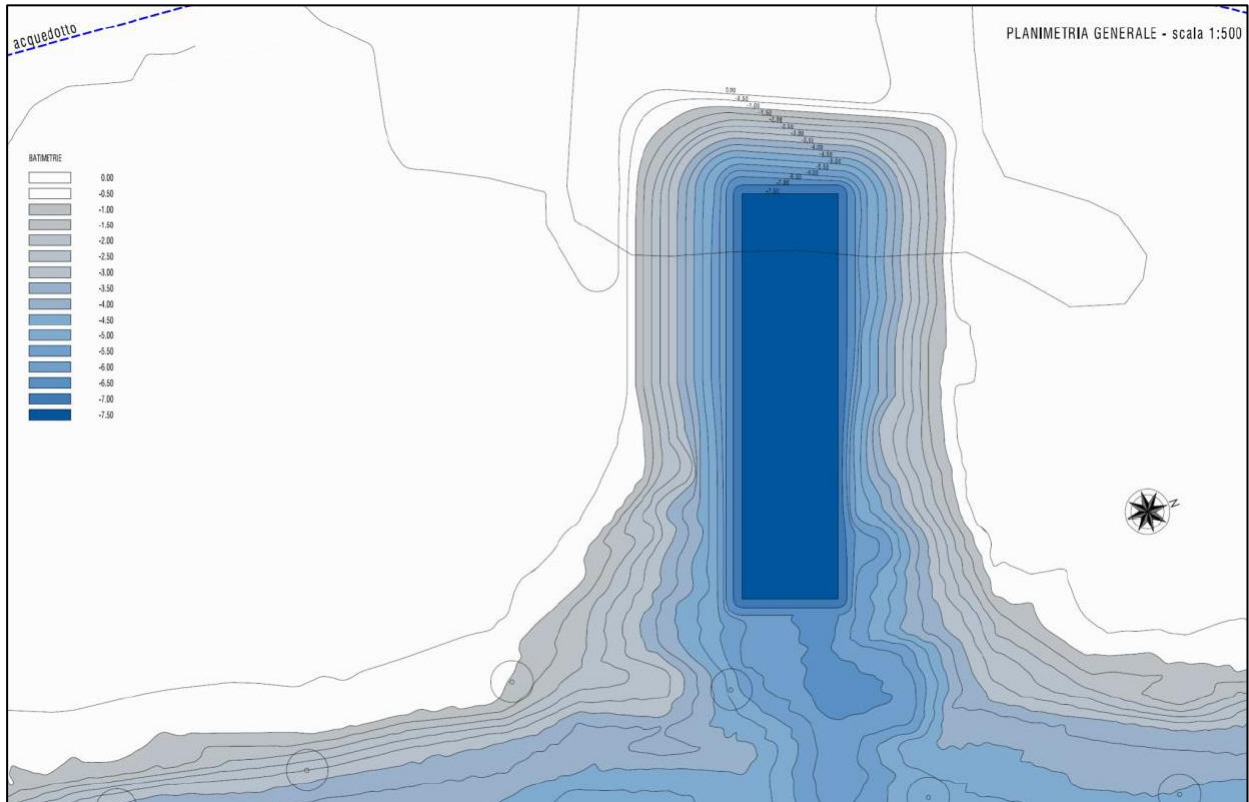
Estratto planimetria di progetto dell'intervento "Adeguamento degli spazi acquei esistenti degli ex Cantieri De Poli"
